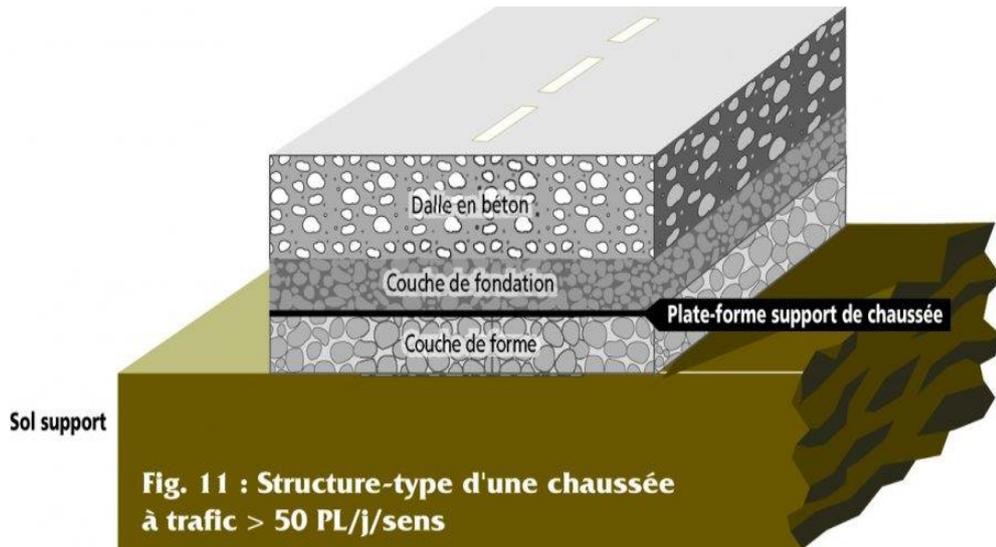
Structure-type d'une chaussée à trafic > 50 PL/j/sens
